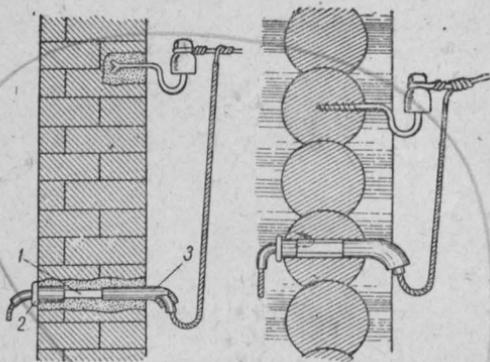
Вводы в здание через кирпичную и деревянную стены:
